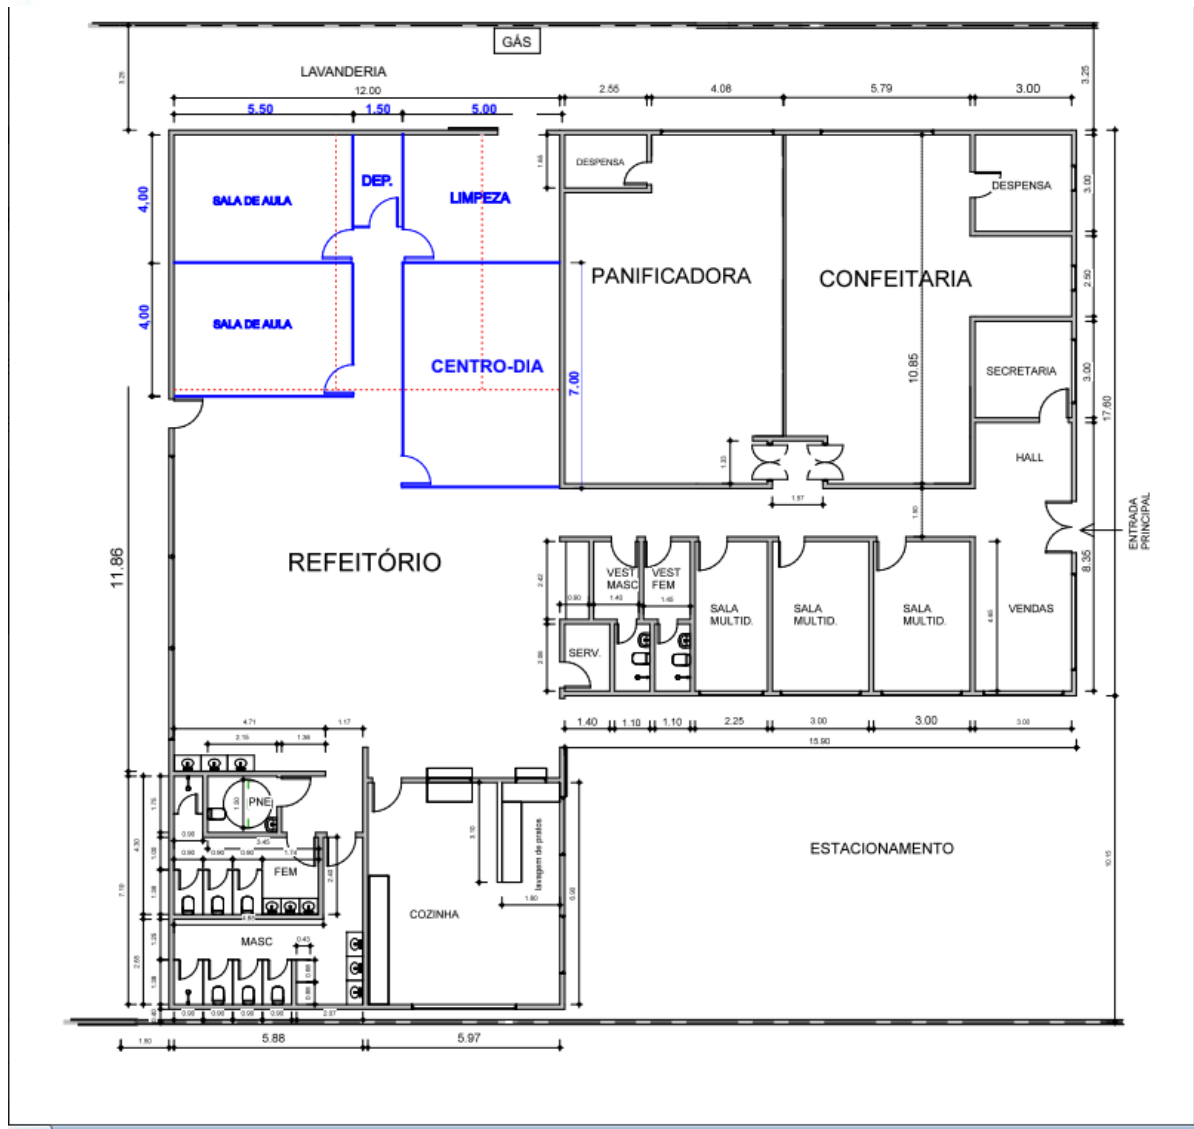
planta do 1º andar da Unidade da Asa Norte.
